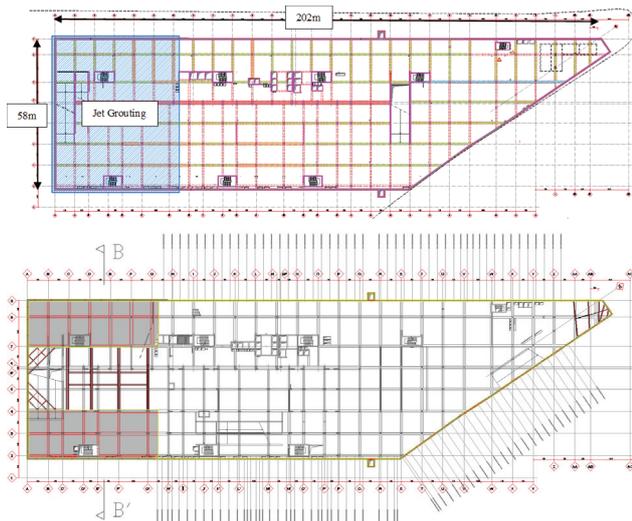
Estrutura *top/down*: planta ao nível da fundação; planta a nível intermédio
